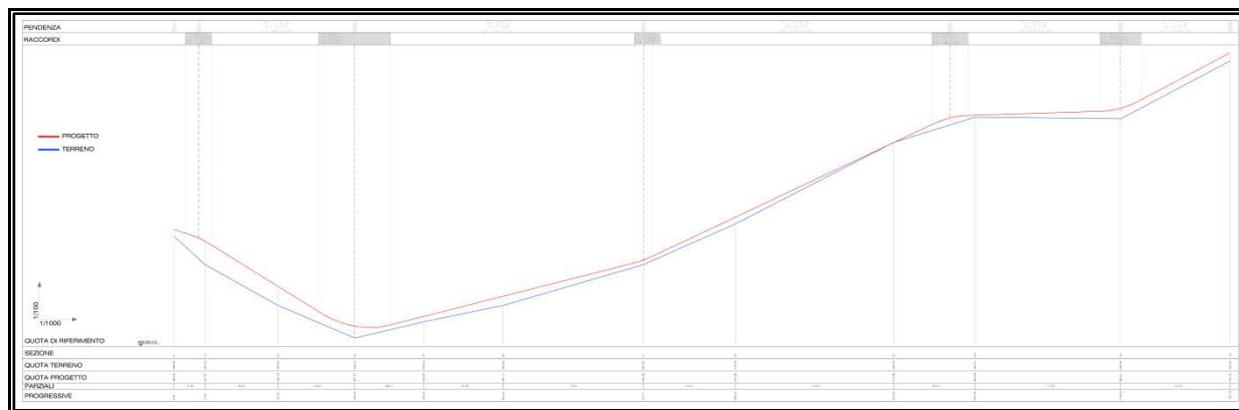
Profilo piano-altimetrico stradale d'accesso (in rosso) alla prevista piazzola cluster (in blu profilo attuale del terreno)
